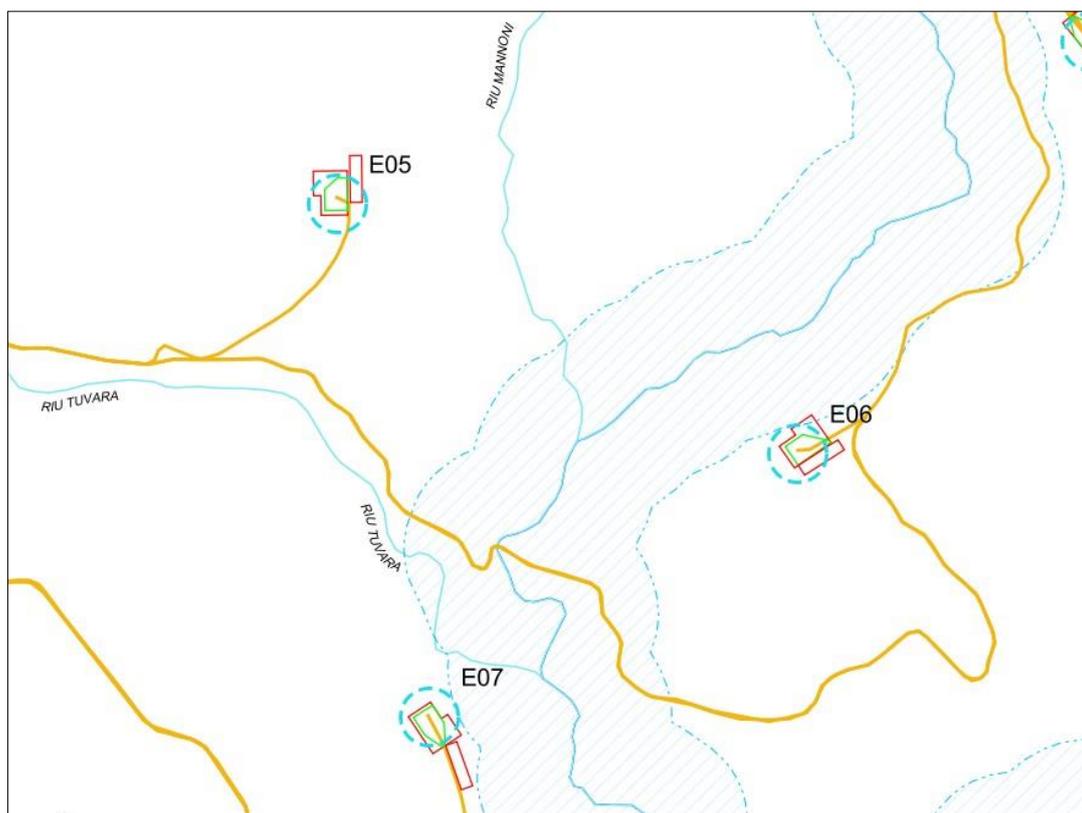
cavidotto interrato tra E06 e E05 e attraversamento riu Mannoni
